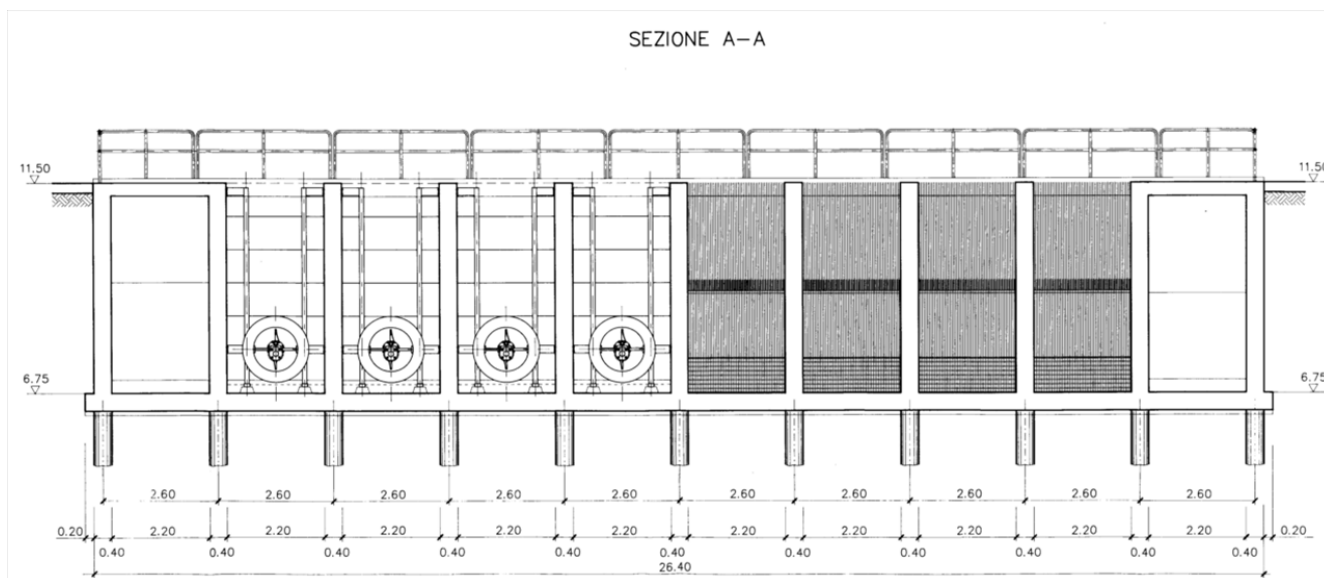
Sezione A-A dell'impianto idrovero Lanterna Vecchia
